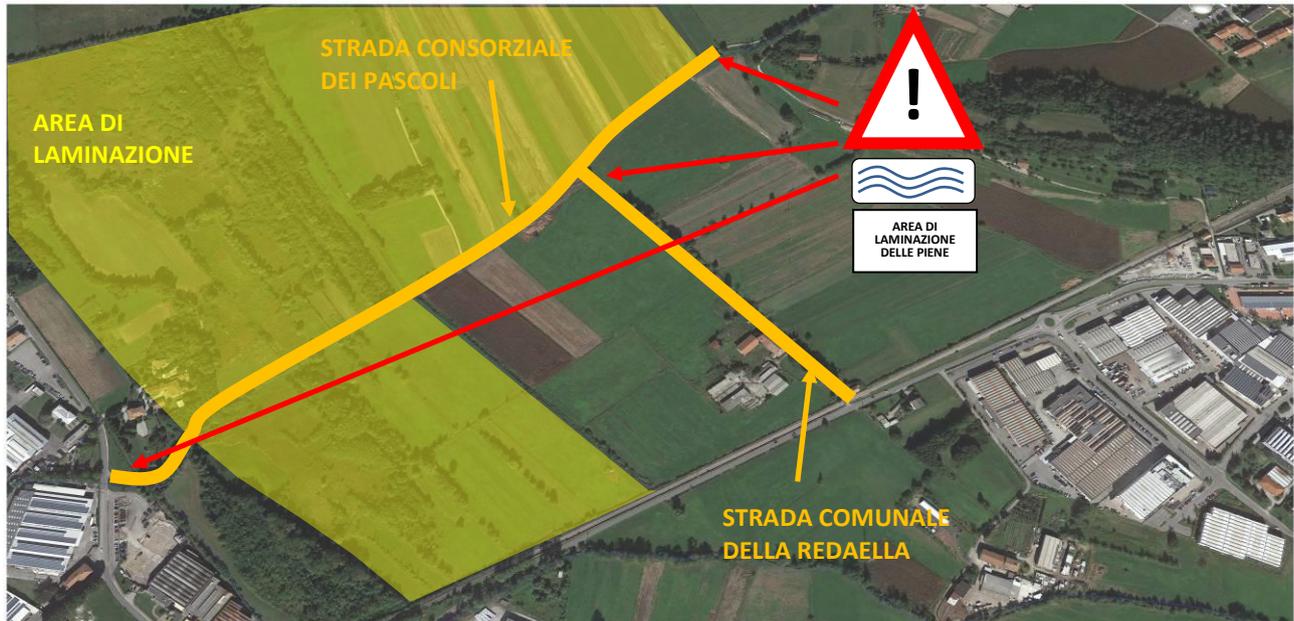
Indicazione planimetrica della segnaletica prevista sulle strade di accesso all'area di laminazione
